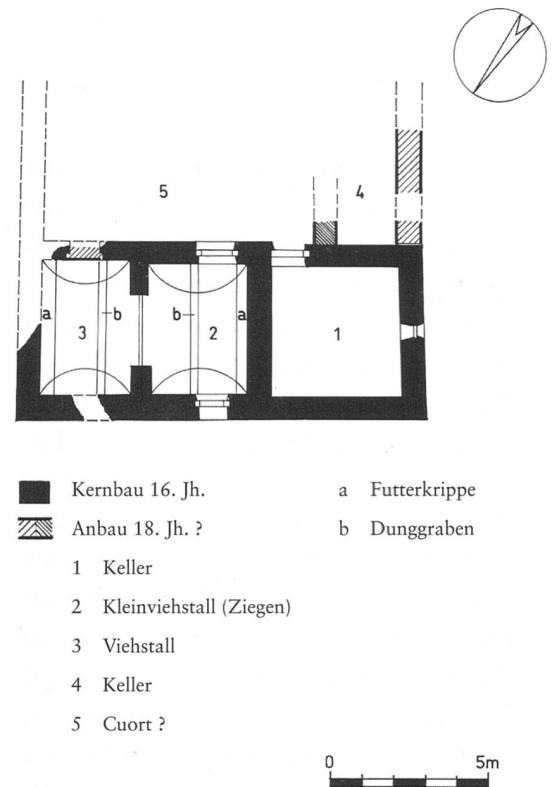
Silvaplana/ Surlej 1997, «Bellavista»; Grundriss, Phasenplan Mst. 1:250.
